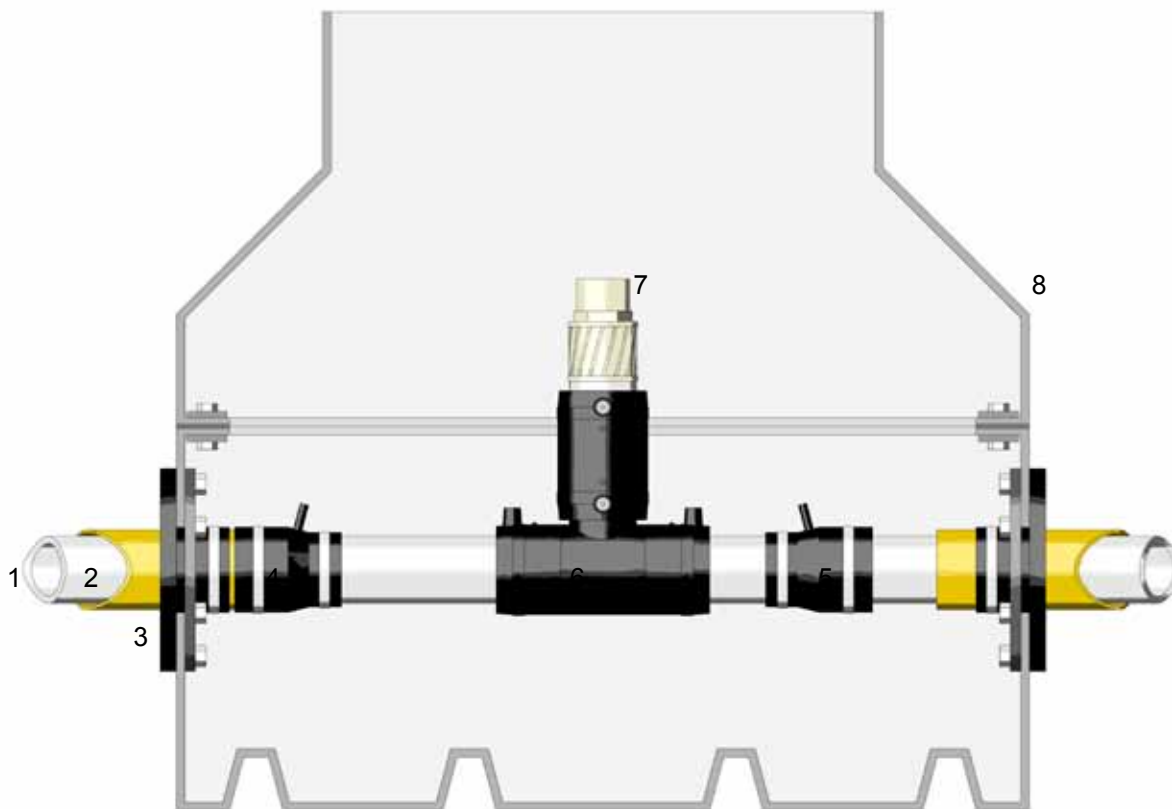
Vista Seccional del Contenedor (6) en Figura. 1 (página 4), Detalles típicos de una conexión de tubería.
